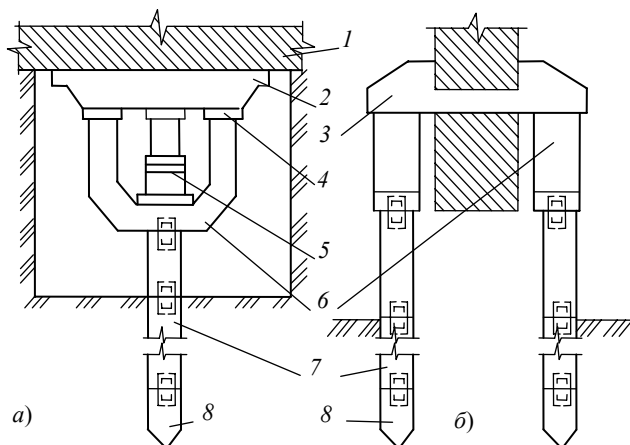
Варианты усиления фундаментов железобетонными задавливаемыми сваями:
